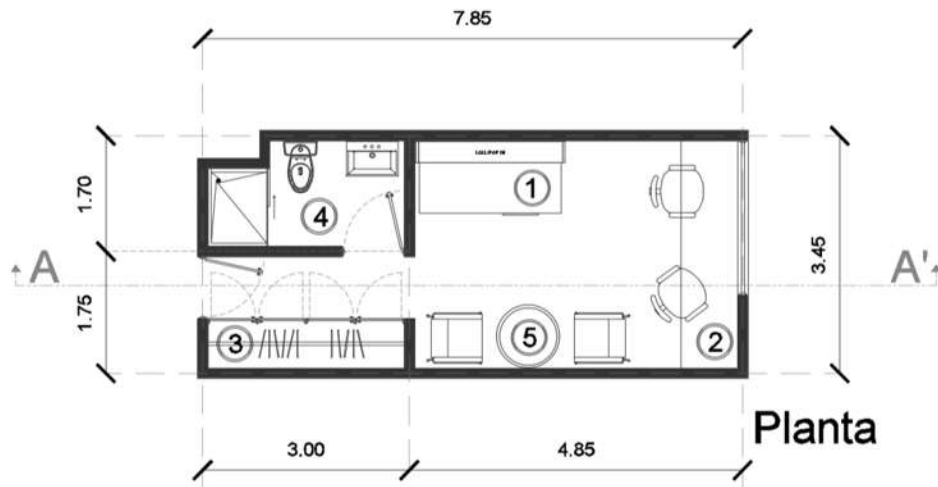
Vista en planta habitación tipo A. Fuente: Autor
